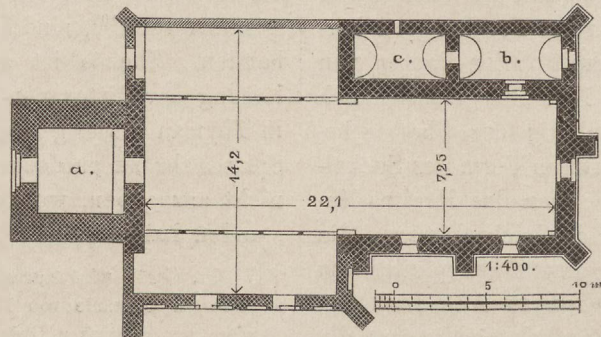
Grundriss der Kirche in Gr. Gartz.
